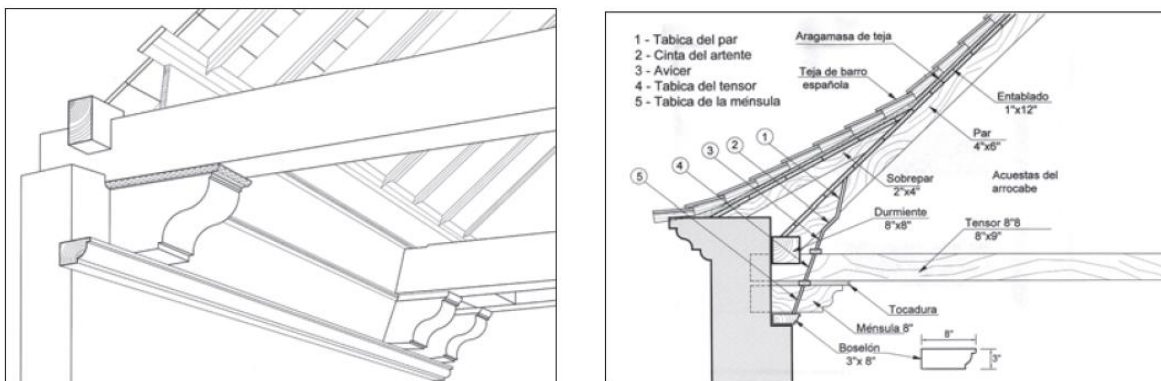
y 10. Detalle en perspectiva de una cubierta/ Detalle cubierta vista frontal.
